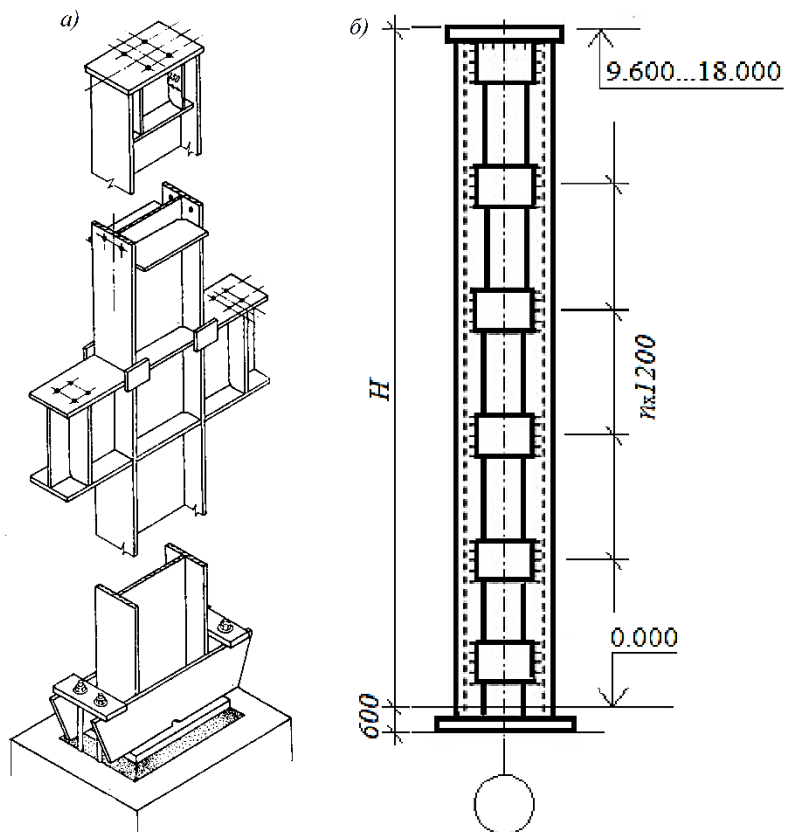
Сталеві колони: *а* – суцільна для будівель з мостовими кранами вантажопідйомністю $Q \leq 20\text{т}$; *б* – двогілкова для безкранової будівлі
